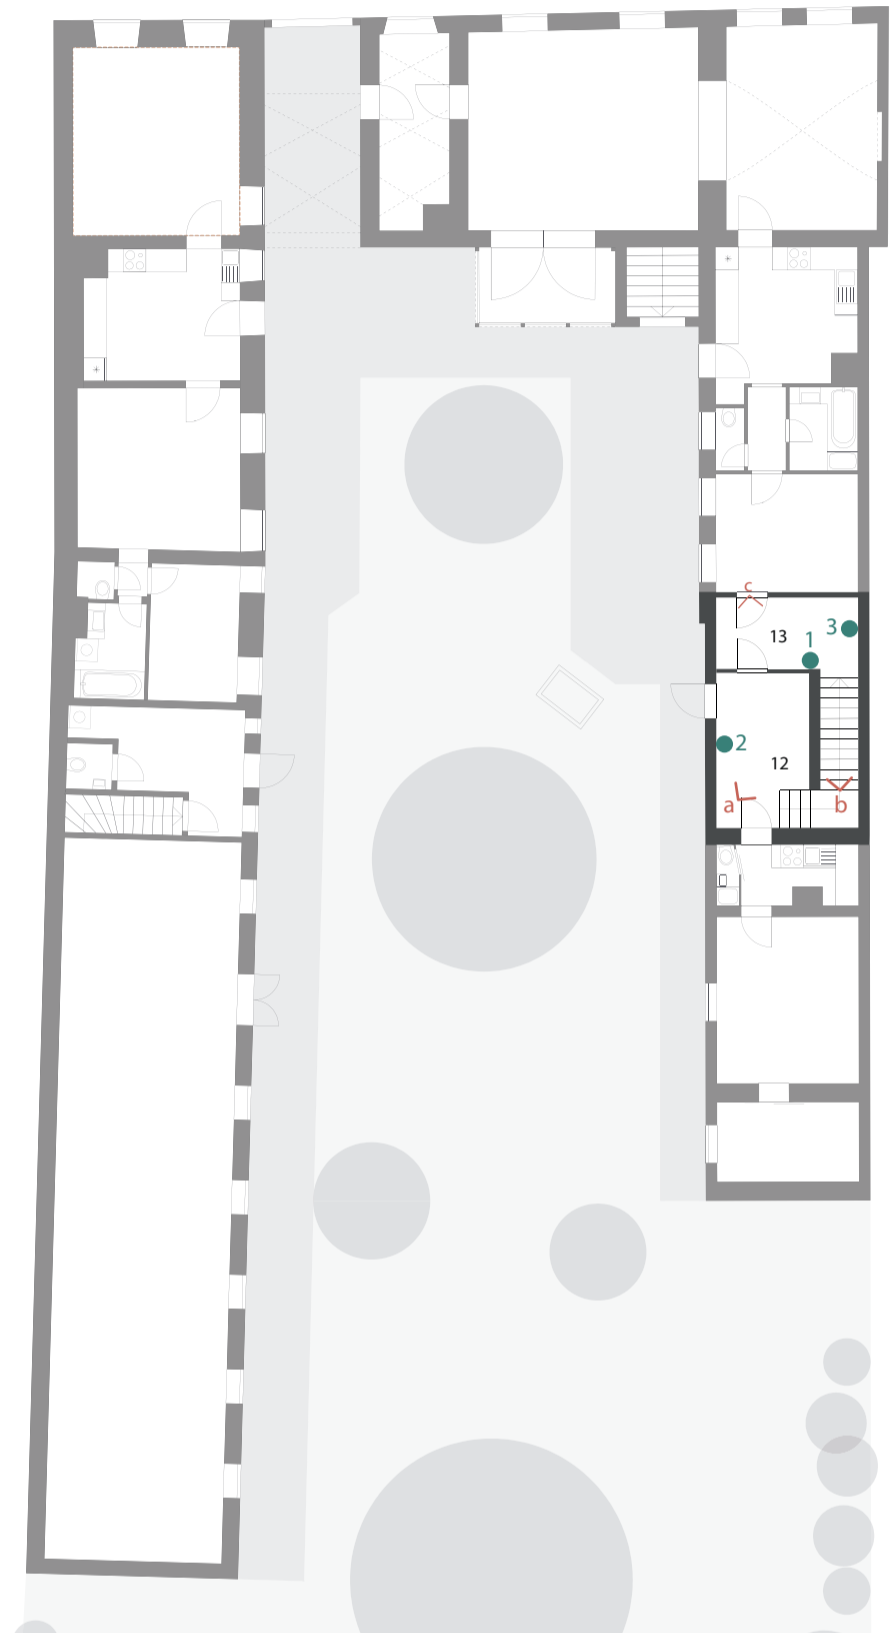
Grundriss Erdgeschoß | M 1:200 | Raum 12, 13
